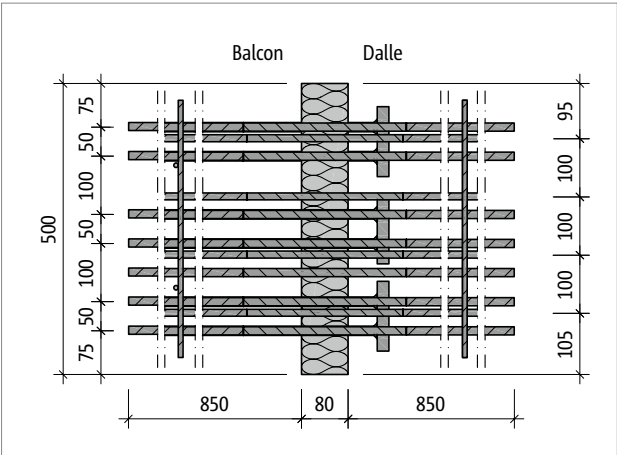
Schöck Isokorb® T type K-T-M13-V3 : plan de base du produit
